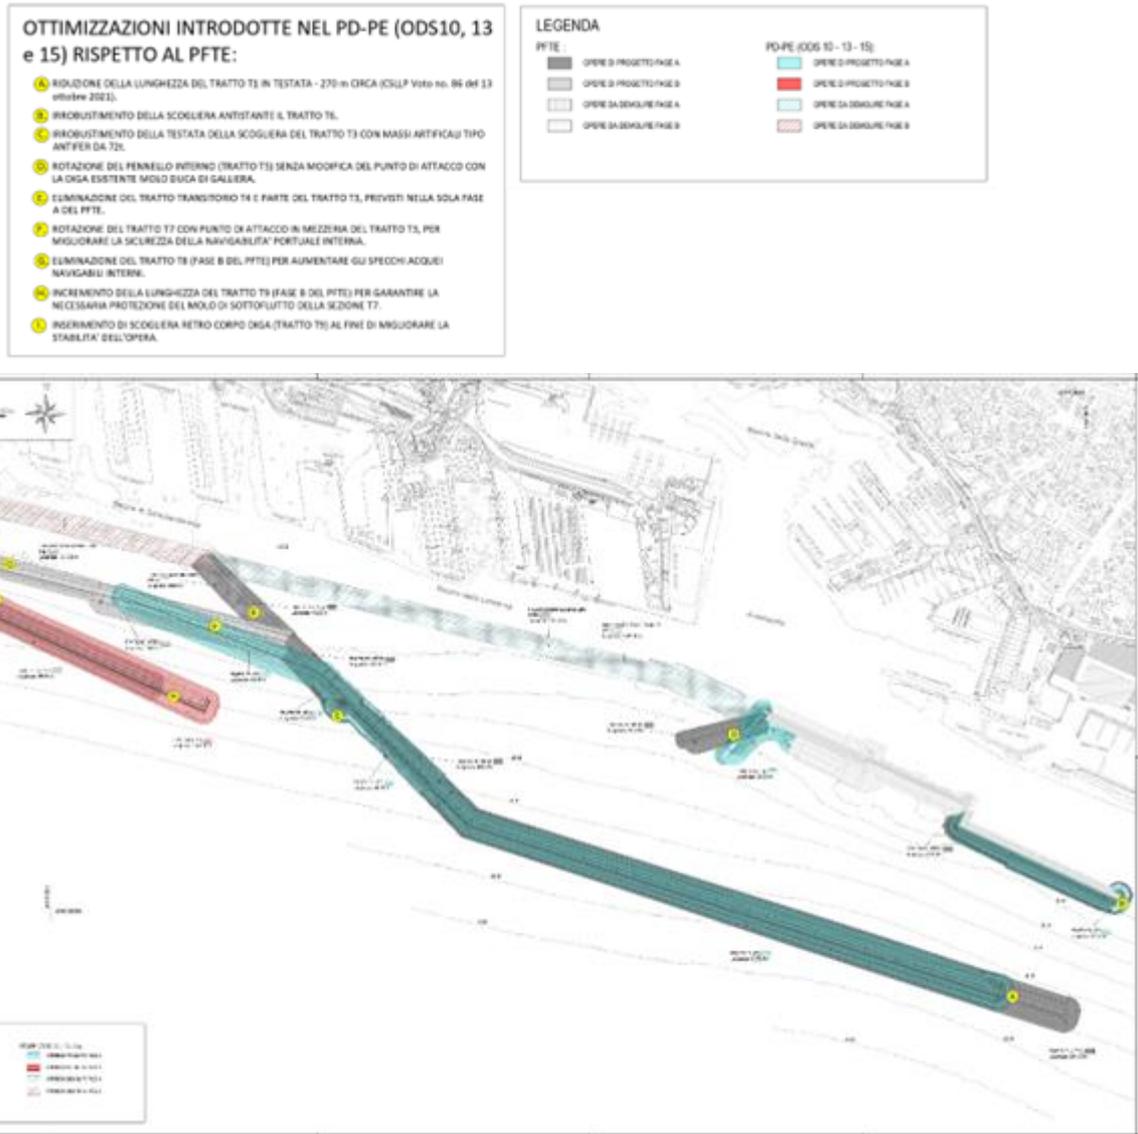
Planimetria generale comparativa Layout PFTE e Layout finale
